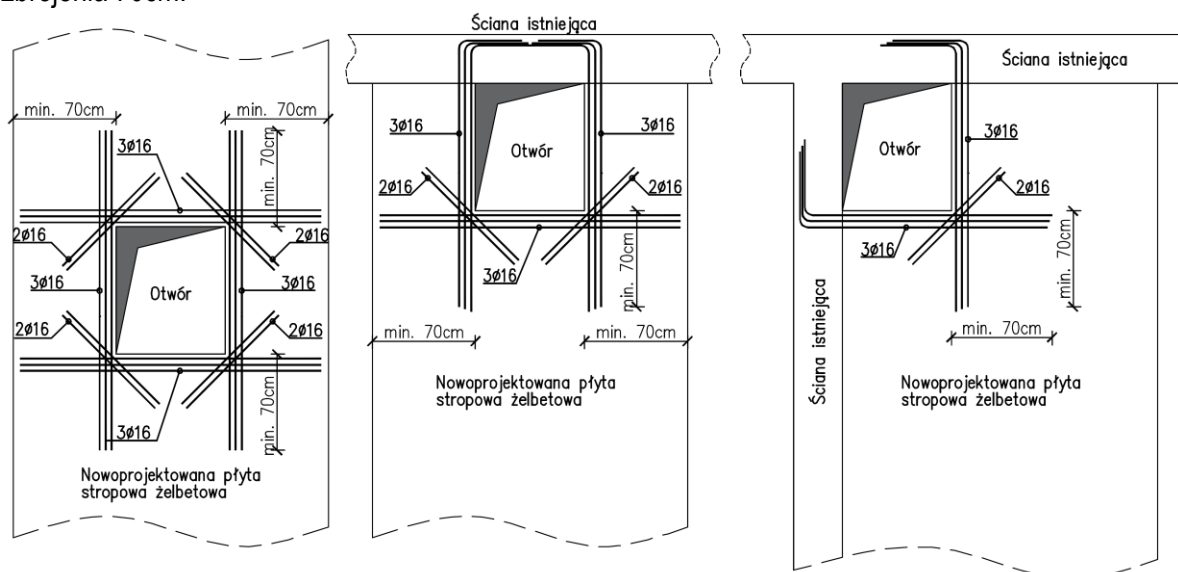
Konstrukcja ramkowa wzmacniająca krawędzie otworu.
